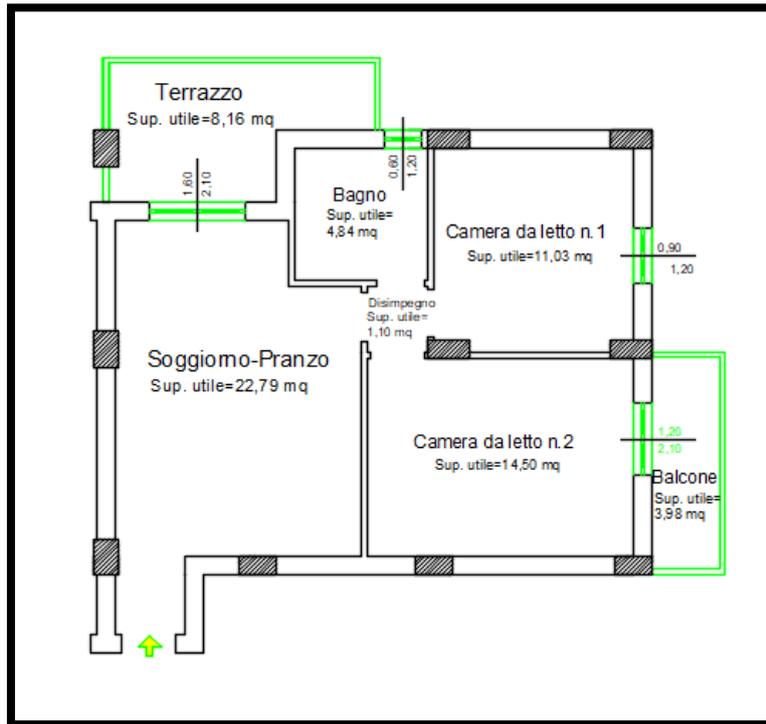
Rilievo del piano secondo – Particella 609 sub 15
